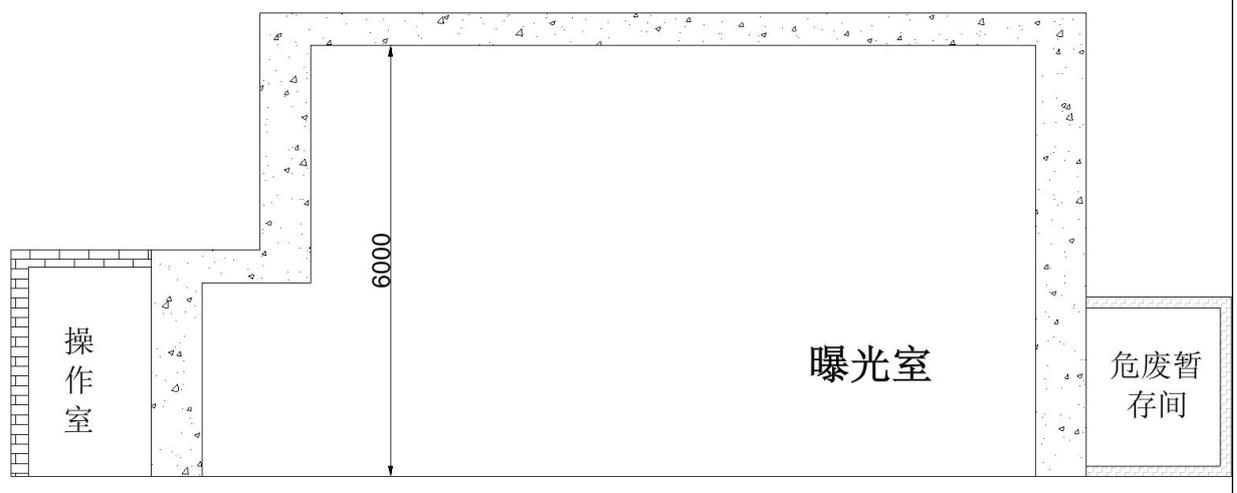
(b) 本期项目探伤室剖面布置图 (mm)
